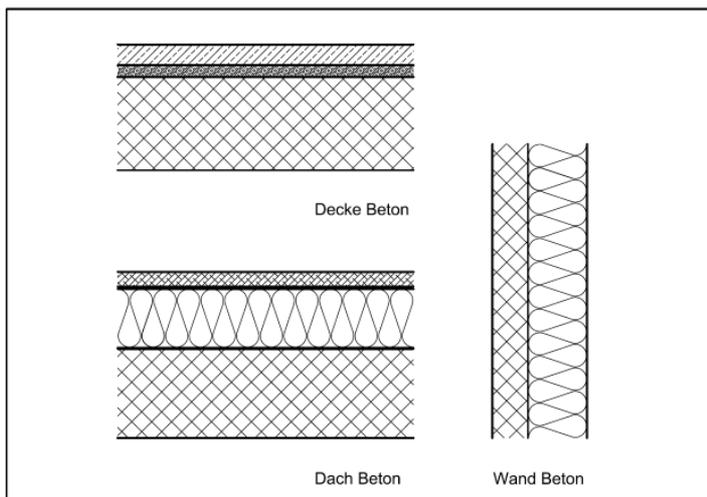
Skizze Aufbau mit Beton (ohne Dampfbremse und Abdichtung), eigene Darstellung
